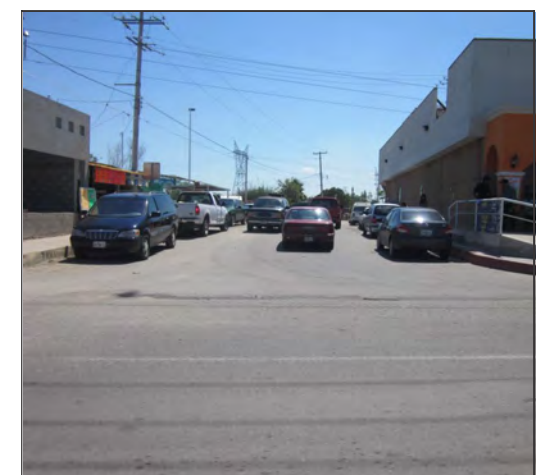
Vista Norte - Sur, sobre la calle Rómulo Córdova. (tramo B)
